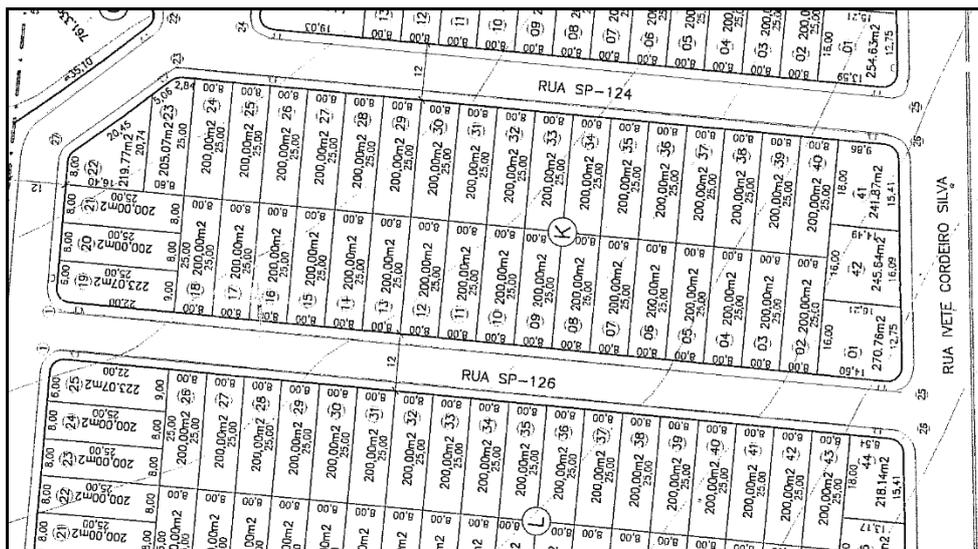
Parcelamento da área, divisão em lotes para implantar as casas populares
